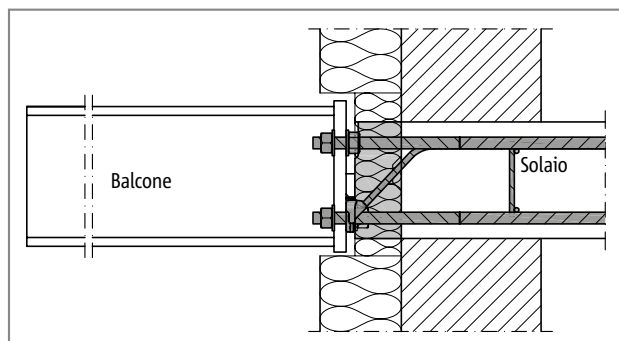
Schöck Isokorb® T tipo SKP: raccordo alla soletta in calcestruzzo armato; materiale isolante nell'isolamento esterno
